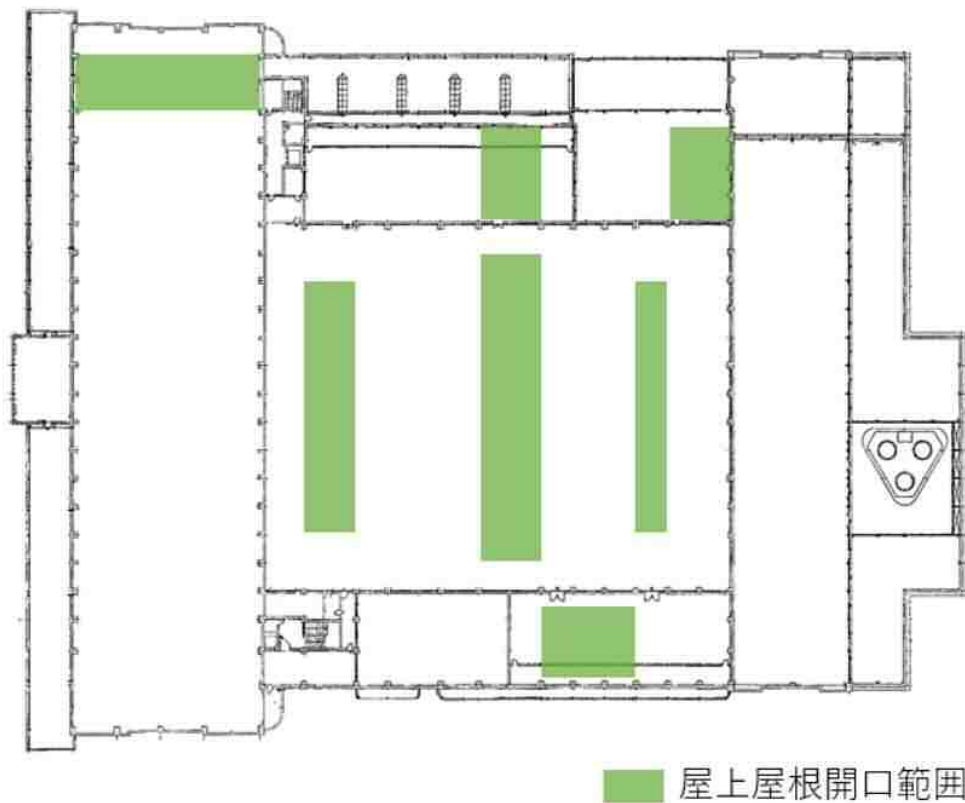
屋上屋根の開口範囲（屋根階平面図）
